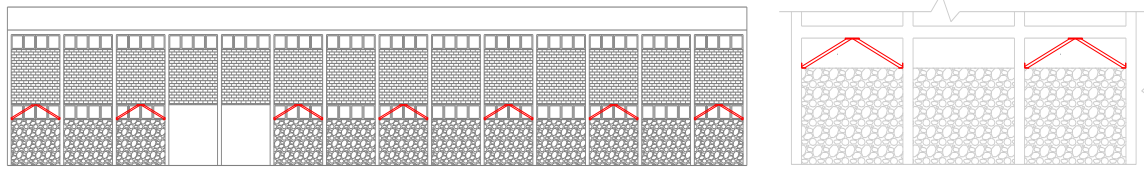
Alternativa R - Disposición esquemática en la fachada (izquierda) y detalle (derecha).
